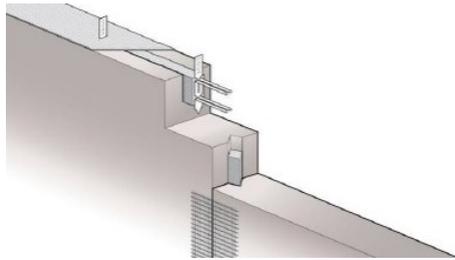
Aussteifung und Verbindung der Wandelemente mittels Beton [40]
